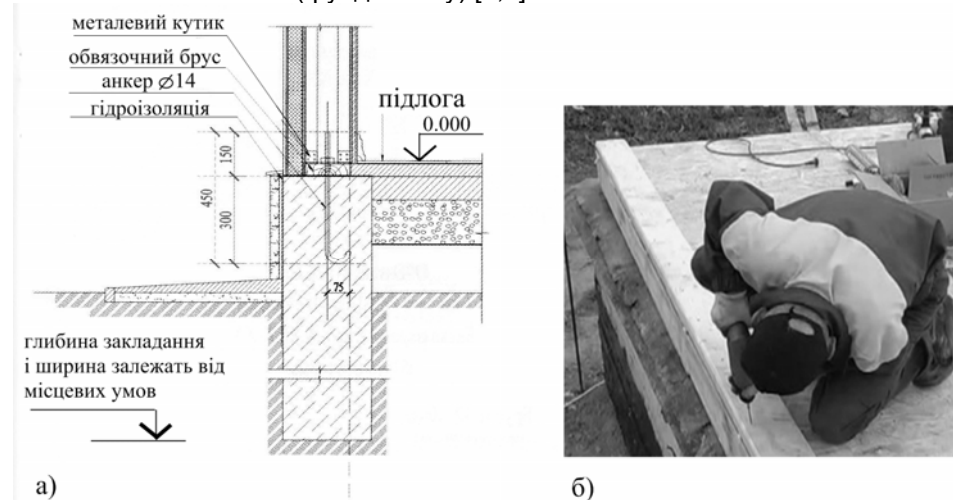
Влаштування фундаменту: а) – вузол закріплення зовнішньої стіни до стрічкового фундаменту; б) - кріплення обв'язувального бруса до стрічкового фундаменту
